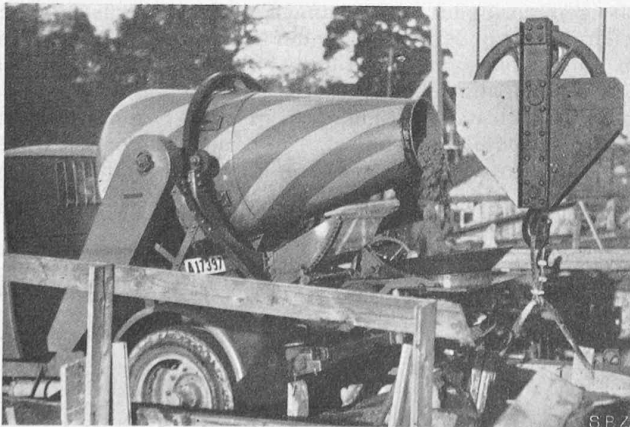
Betontransportauto von der Betonfabrik zur Baustelle.
